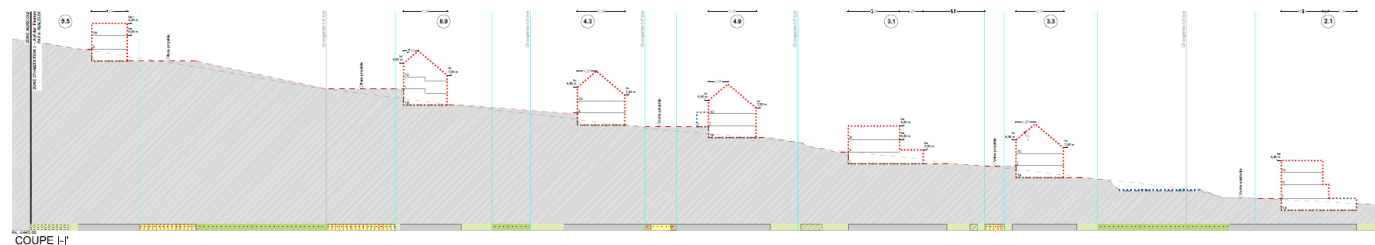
Exemplarischer Ost-West-Schnitt der Planzone (Quelle: planetplus 04.12.2020). Größere Darstellung in Anhang 01. Der Schnitt entspricht in etwa dem grünen Profil in Abb. 22.
